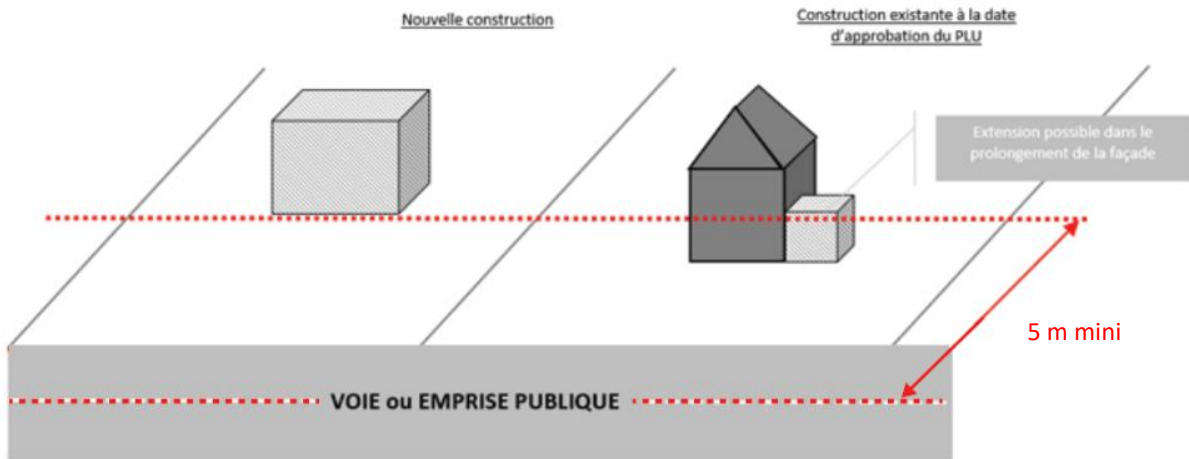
Implantation dans le prolongement de la façade pour les extensions des constructions en zone Uc en agglomération
